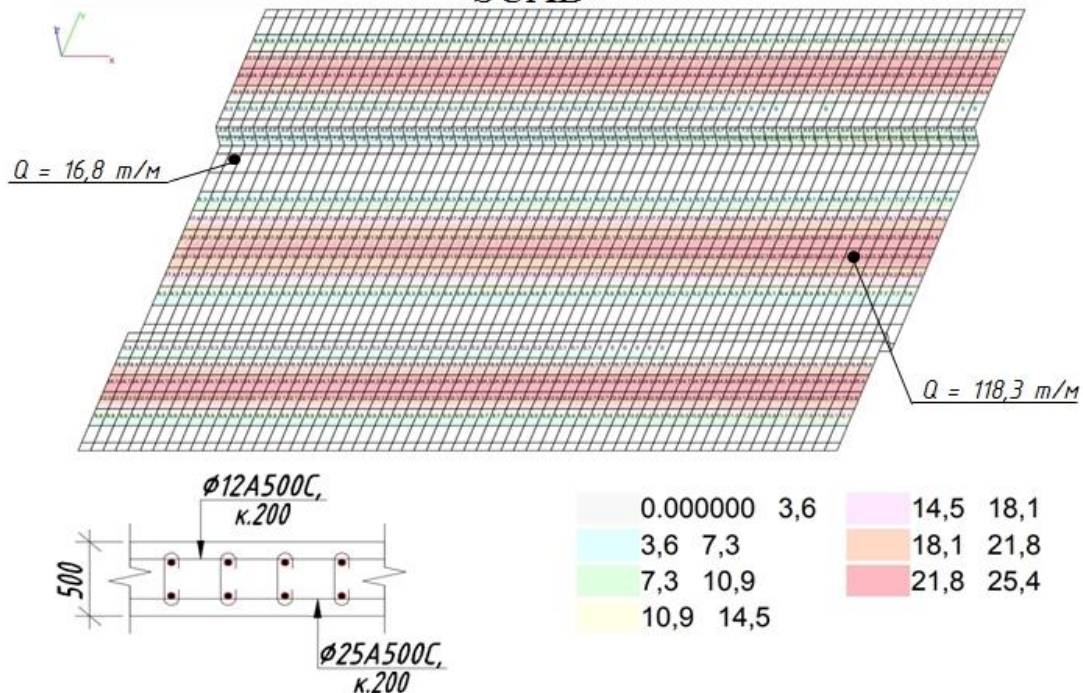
Результат розрахунку поперечних сил, що діють у лотковій плиті, та підібрана на їх основі поперечна арматура в програмному забезпеченні SCAD
